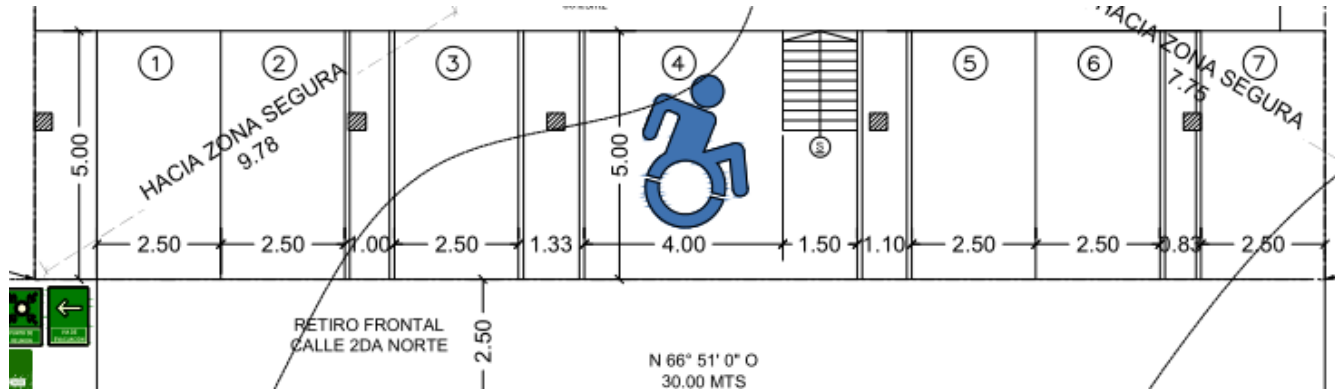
ESTACIONAMIENTOS. PLANTA BAJA "MOON TOWER"
